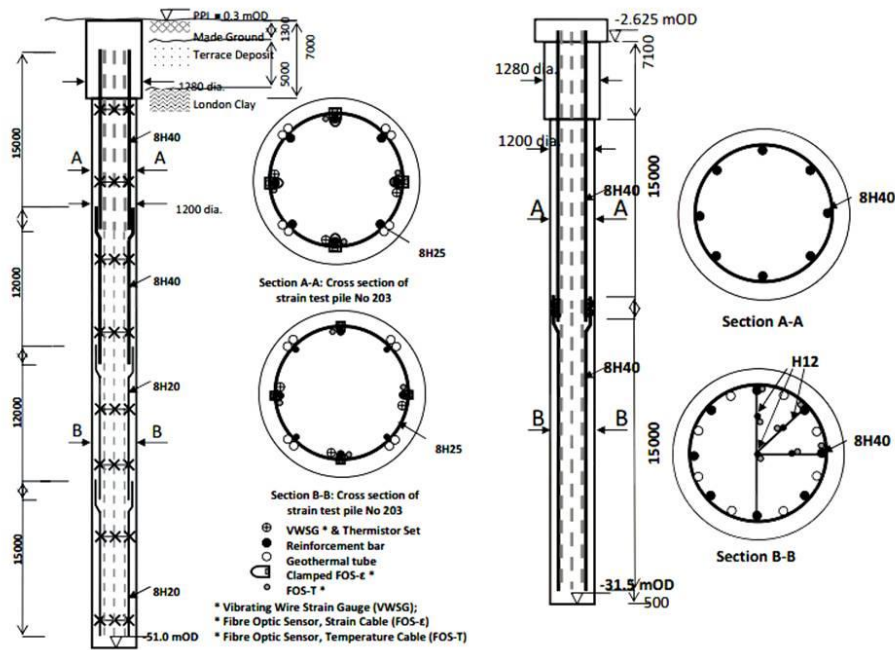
Detalles de la instrumentación en el complejo Bankside (Ouyang, 2011a)
